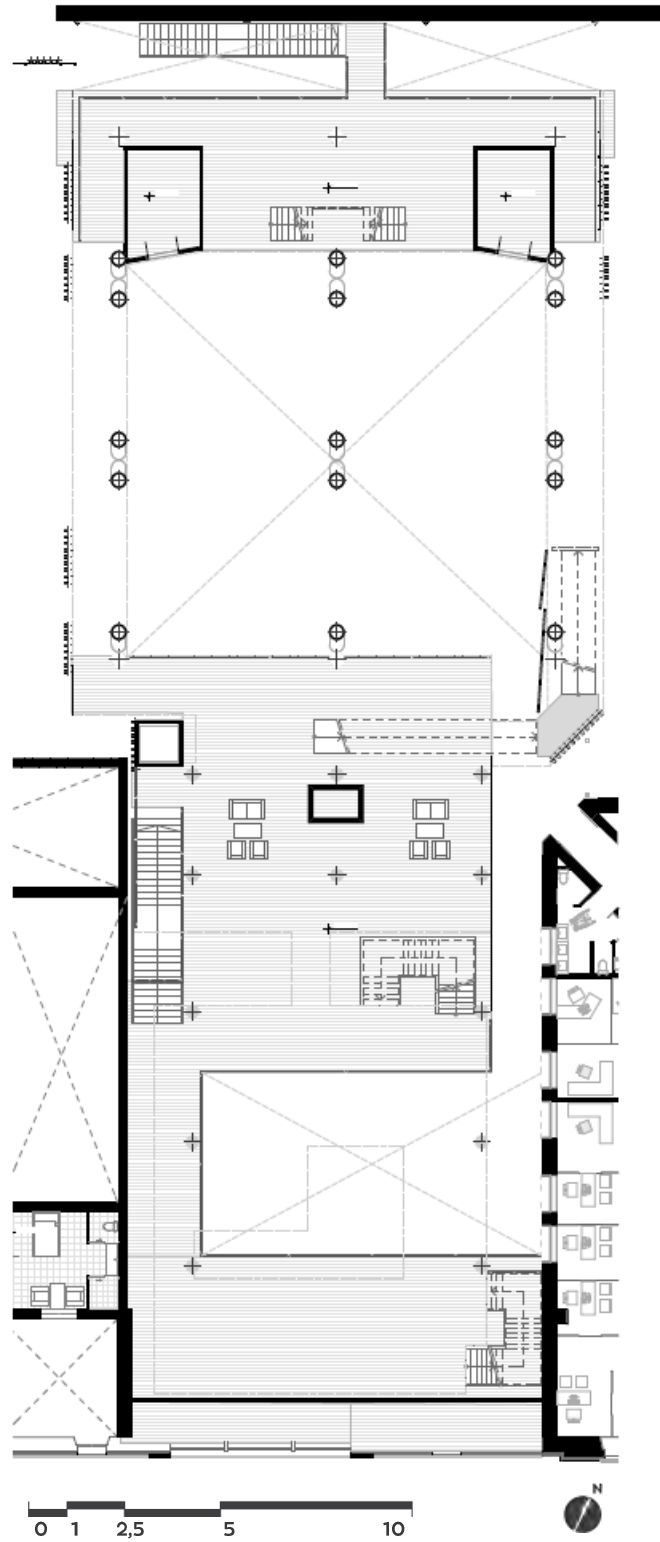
Planta Vestíbulo Sala de Música. Fuente: Elaboración Propia.
